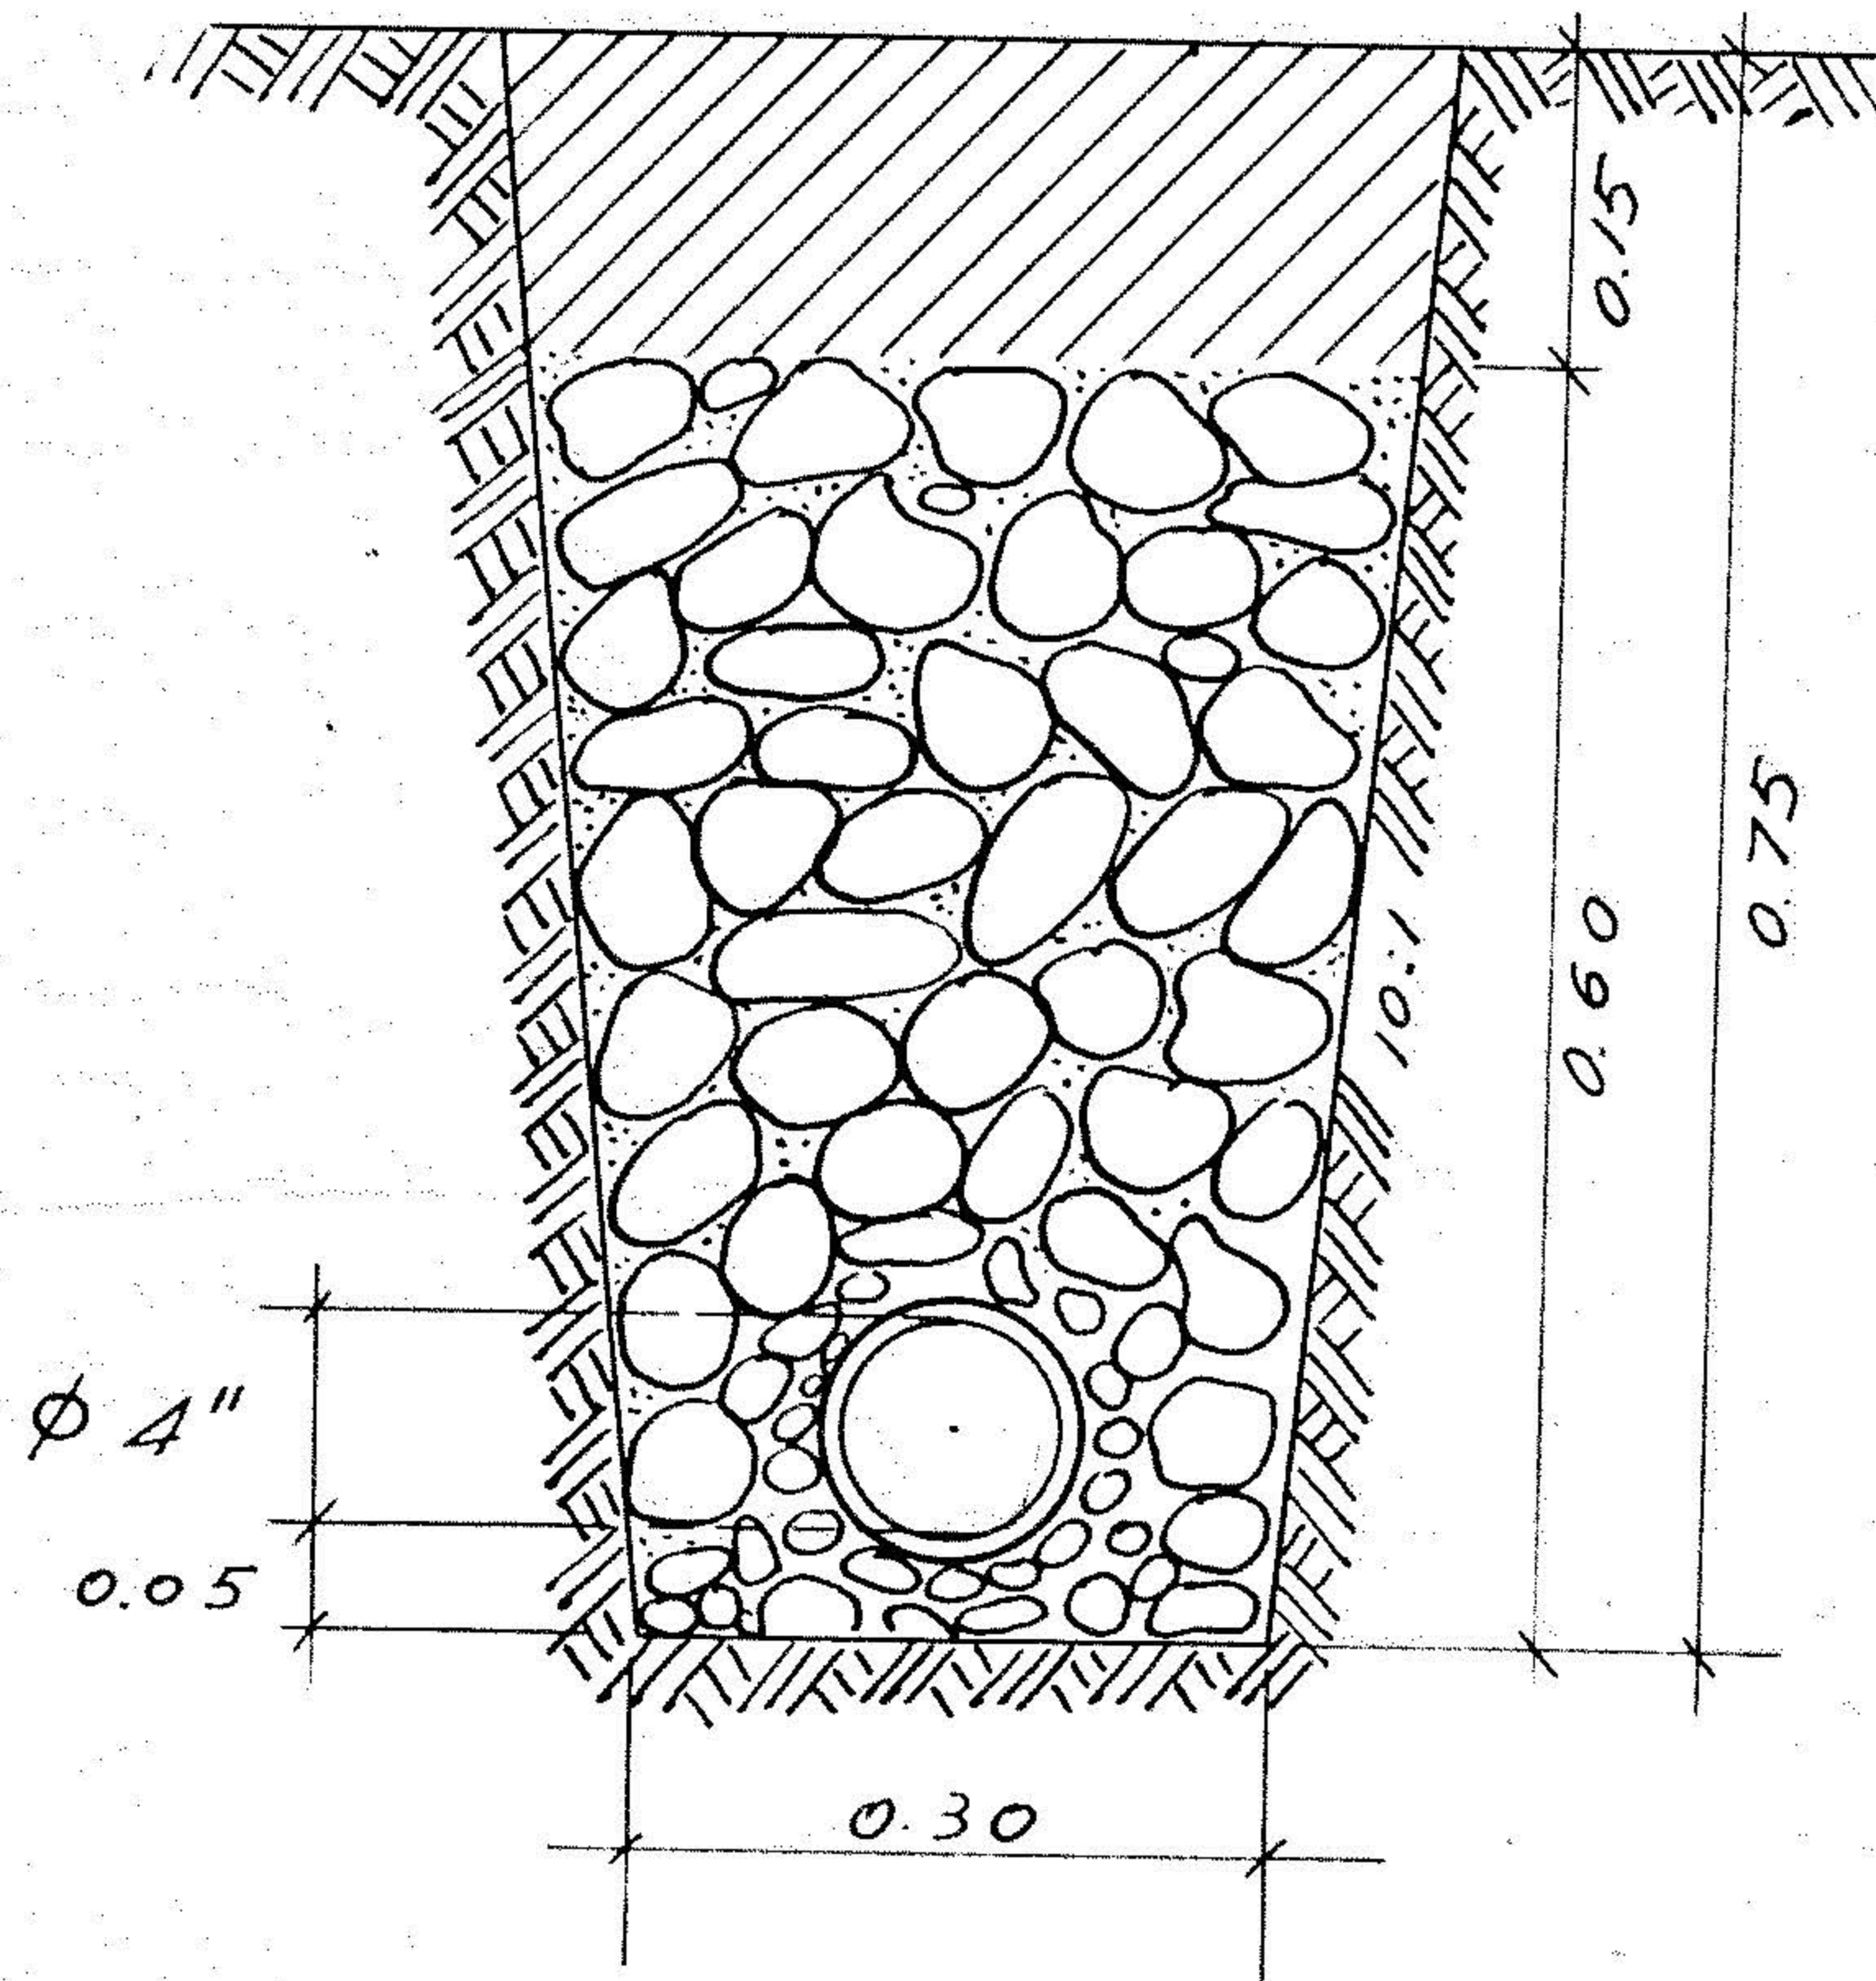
SUB-DRENAJE INDICANDO LAS MEDIDAS MINIMAS
